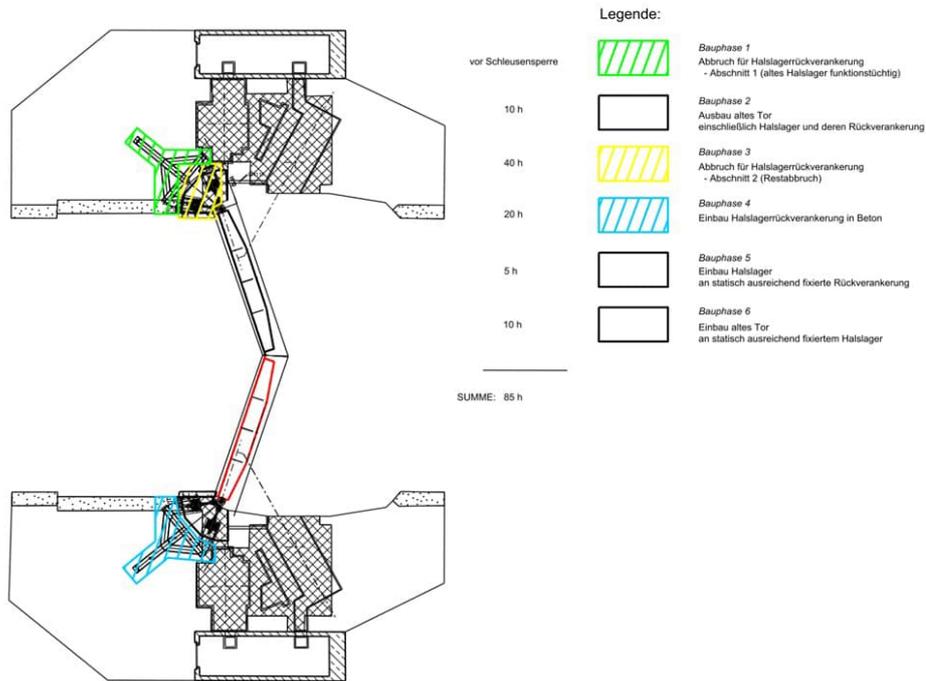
Bauphasenplan 1 Ersatz der Halslager einschl. deren Rückverankerung
